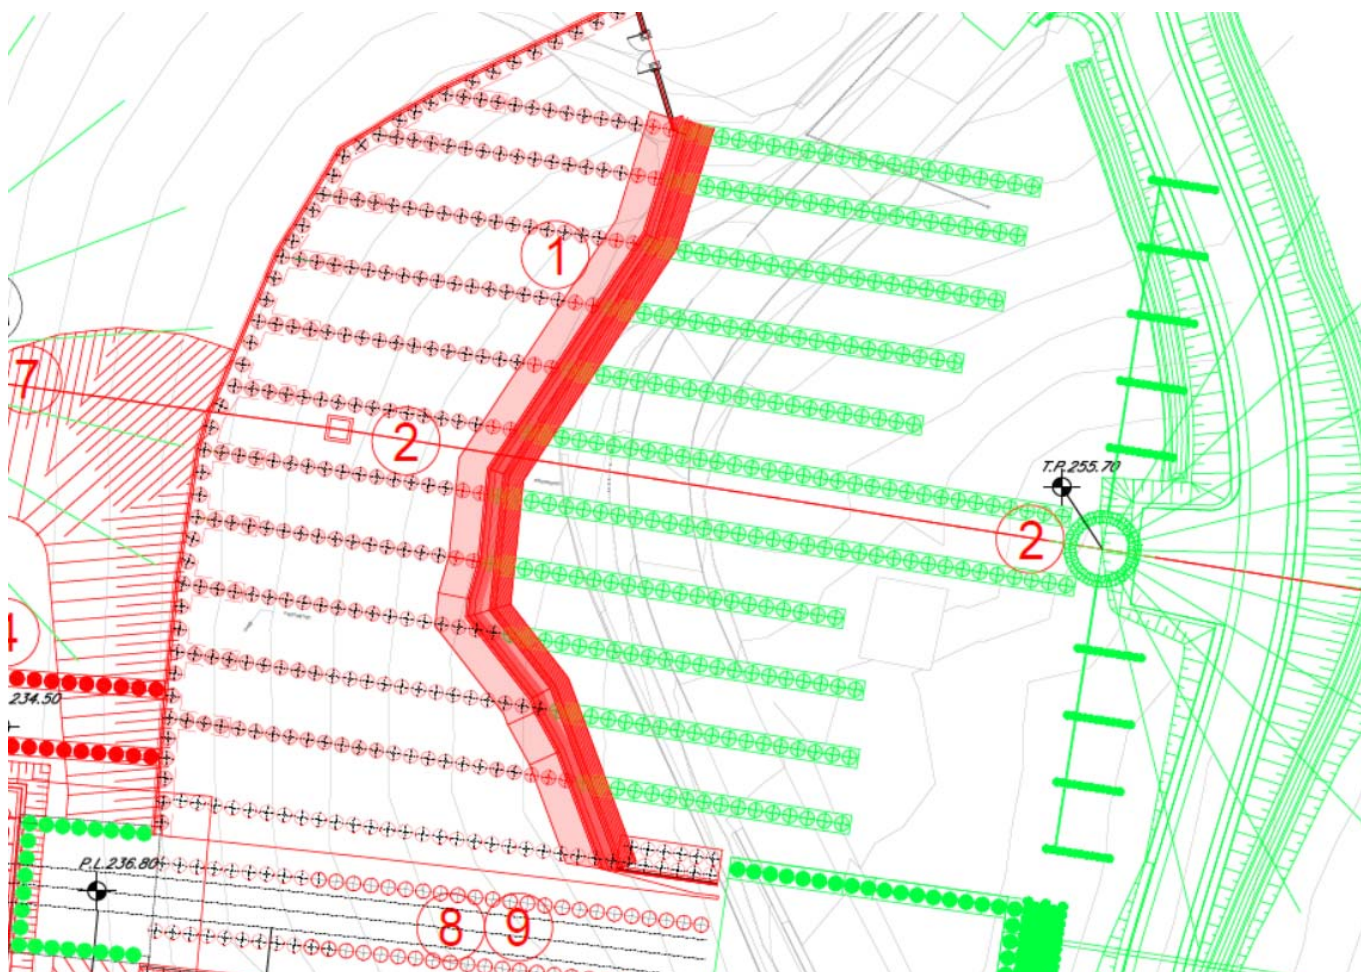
Estratto da planimetria fasi costruttive [25]
